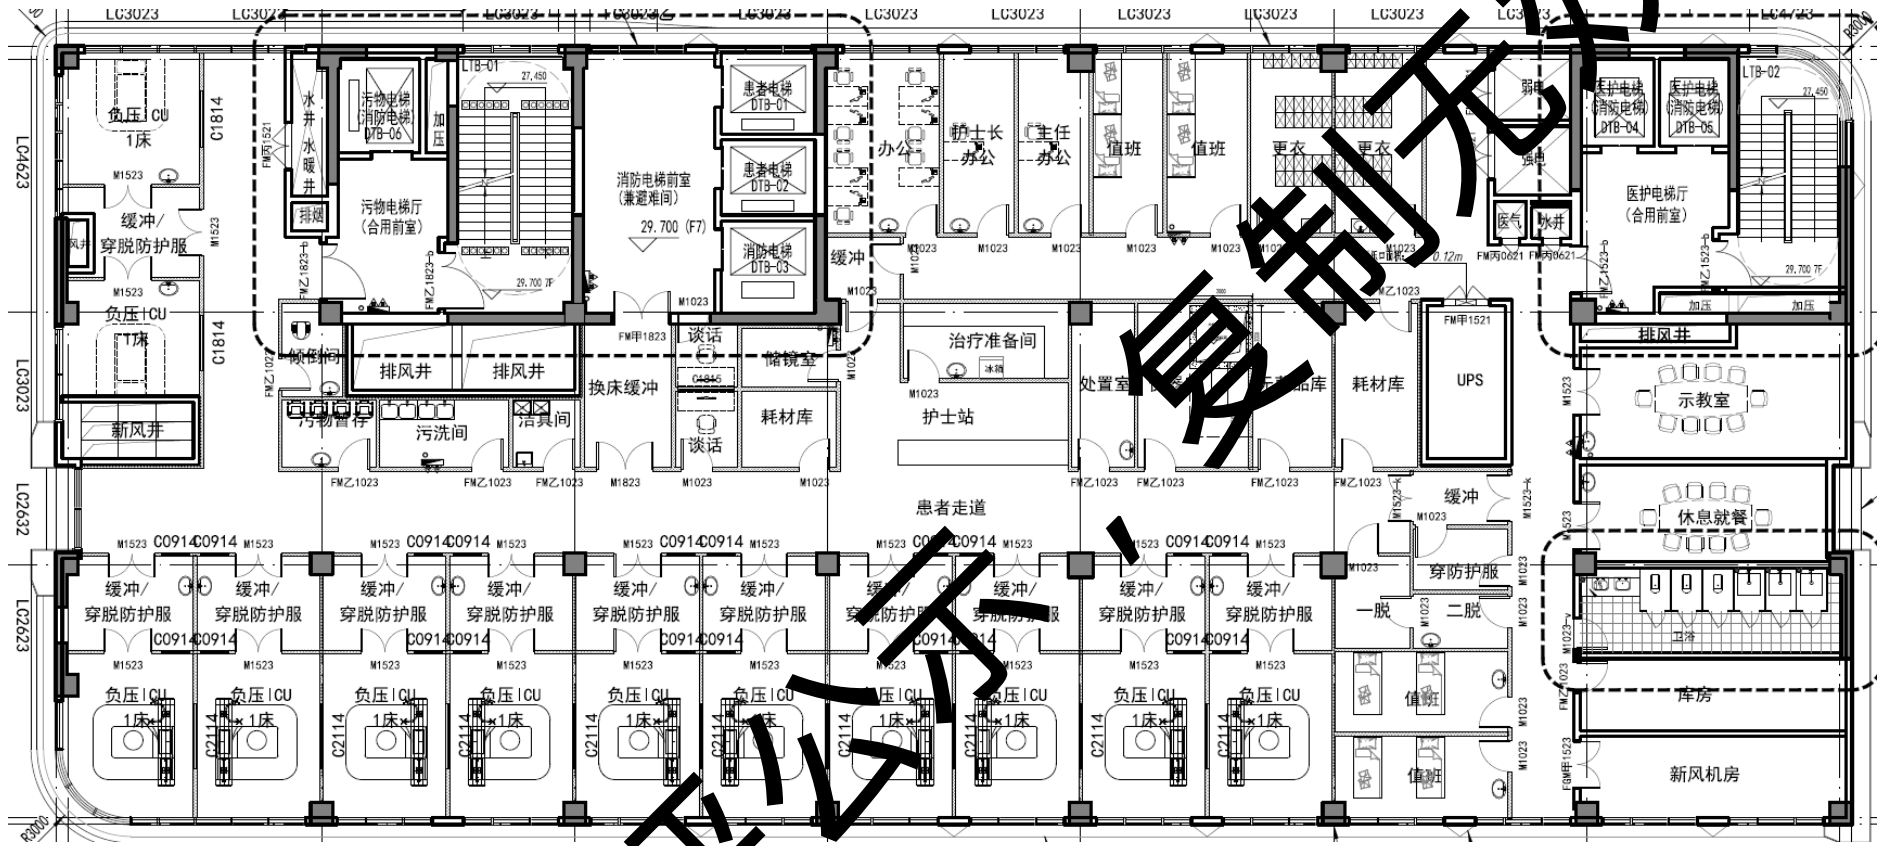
本项目新建应急中心楼 7F 平面布置图
